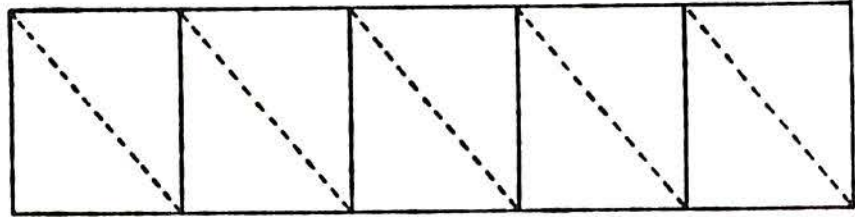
Detalhamento da viga de concreto armado utilizada nas comparações
